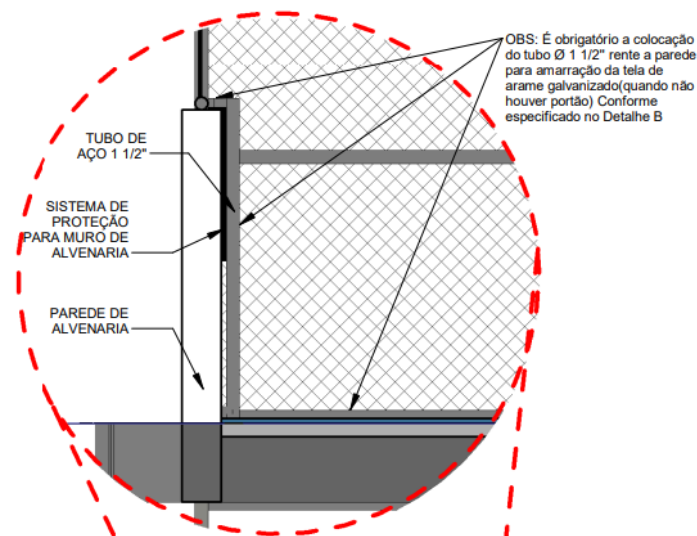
Detalhe da fixação das telas (Fonte: Autor/2024)
